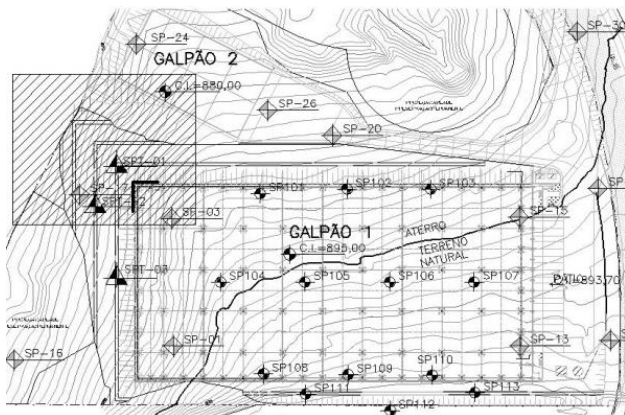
Planta Chave – Localização do Galpão e Trecho analisado (hachura).
